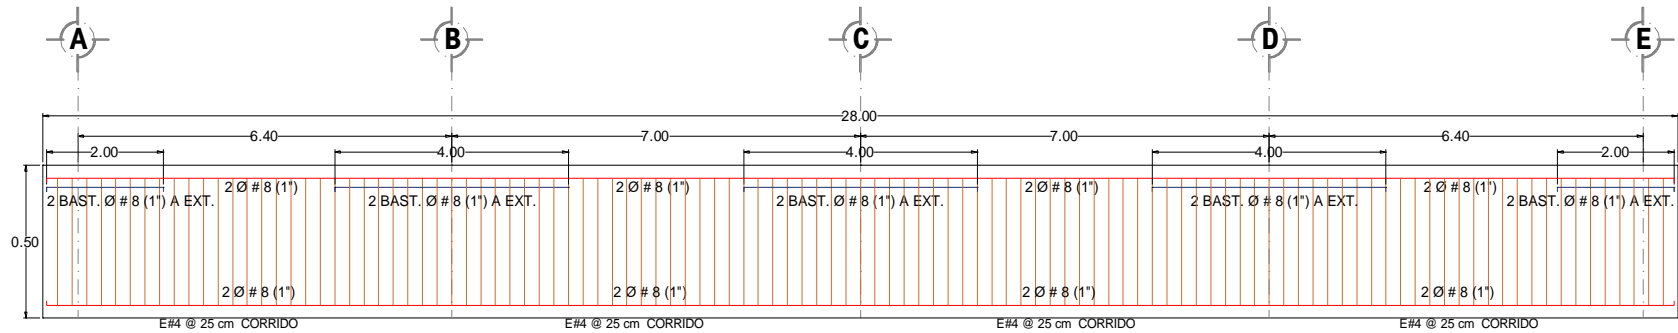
Detallado de armado de vigas y columnas del marco de 9 niveles con base a secciones gruesas.
